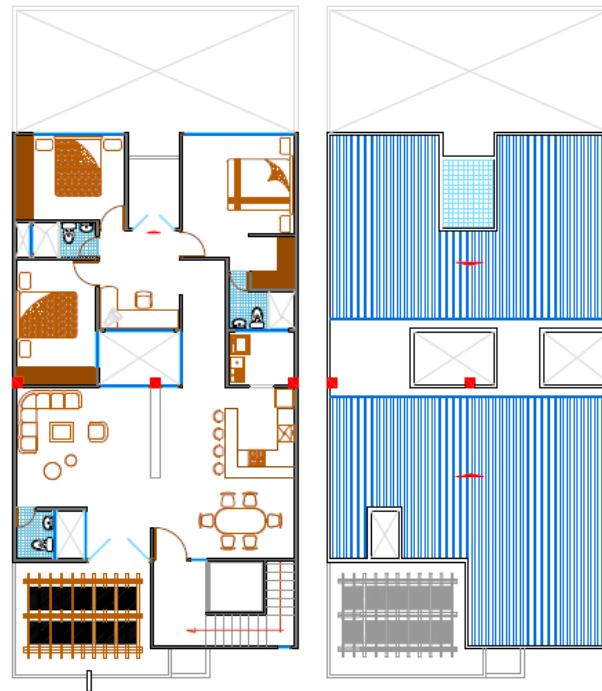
Planta tipo (1, 2, 3, 4 y 5 piso)
